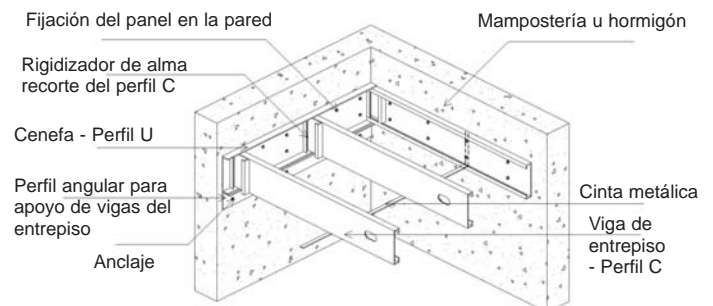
Losa en Steel Framing apoyada sobre estructura tradicional.
